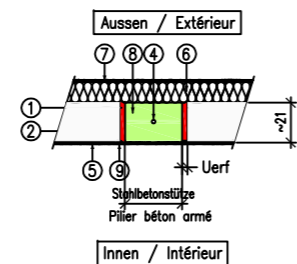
Prinzip für die Fassaden ab 1. Obergeschoss
